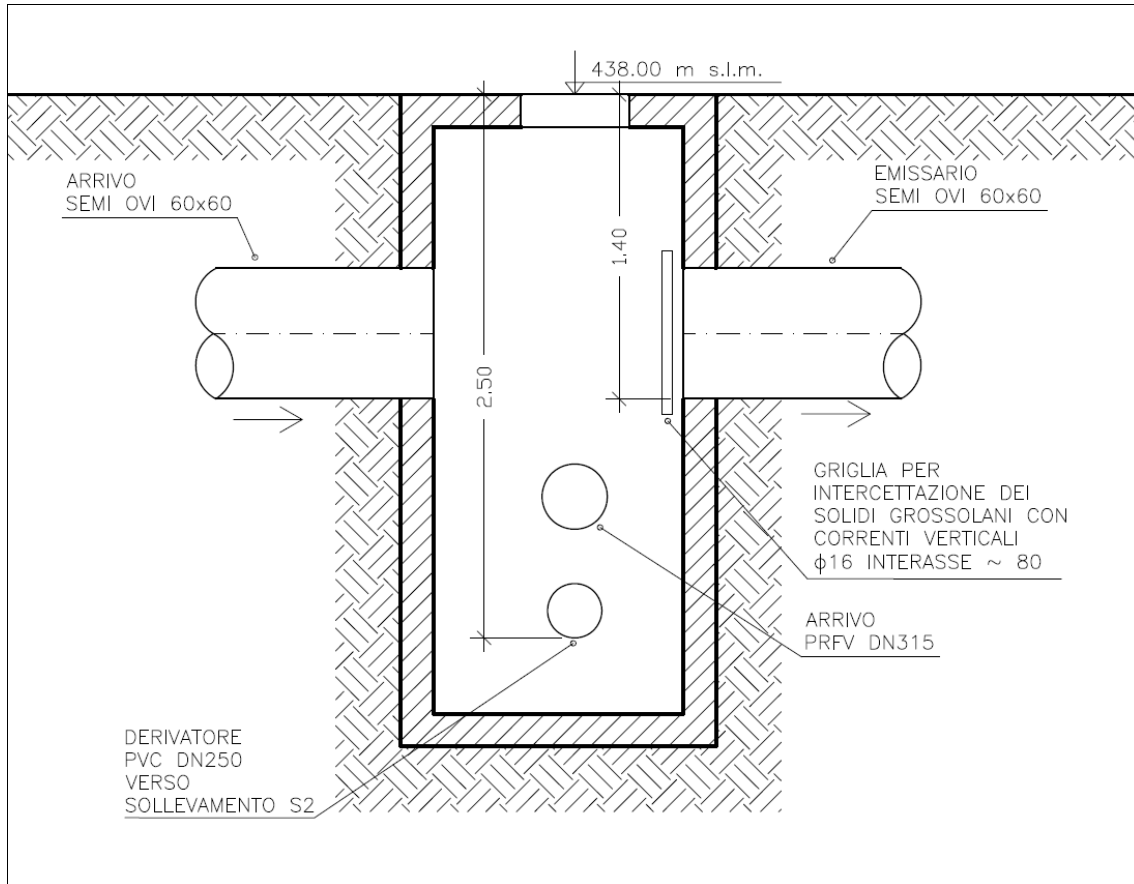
Sezione scolmatore di progetto – Pozzetto N
